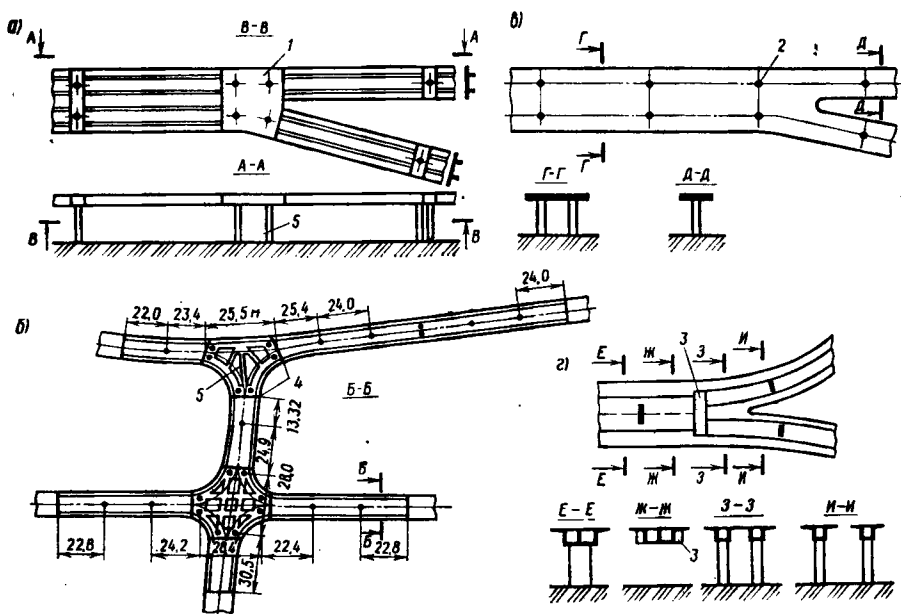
Конструкция разветвлений пролетных строений железобетонных эстакад:
